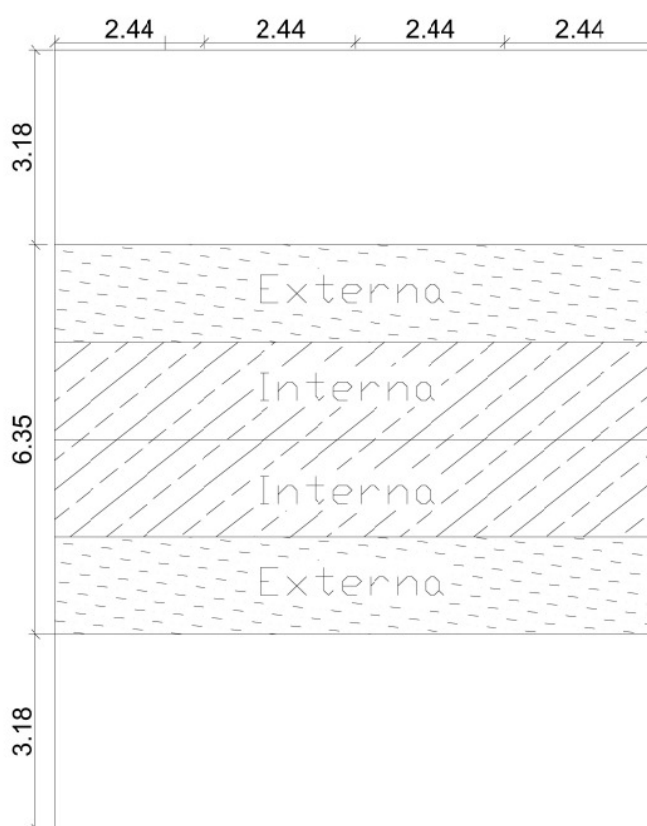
Divisão de Faixas Internas e Externas do Pórtico B
